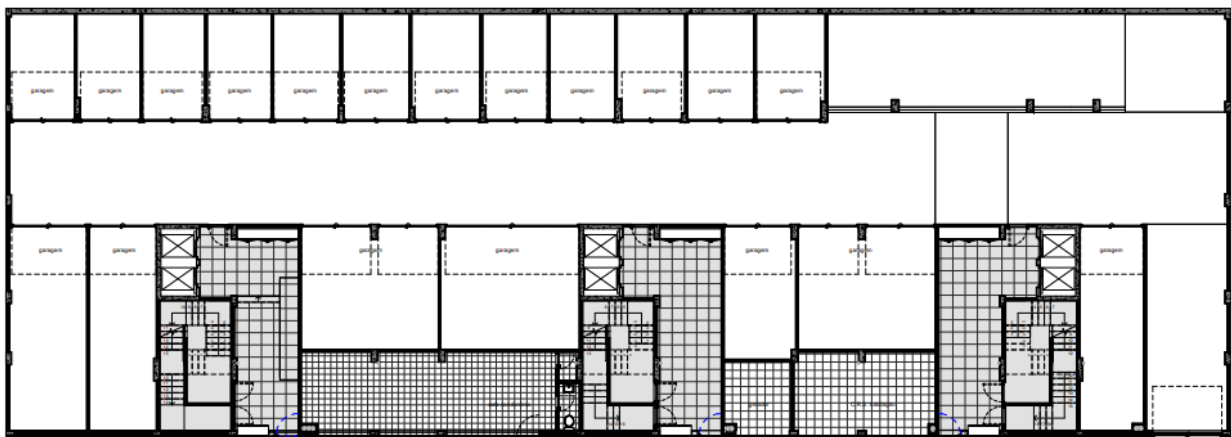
Recorte da planta de arquitetura do piso -1 do edifício Altavista 17 (1).
